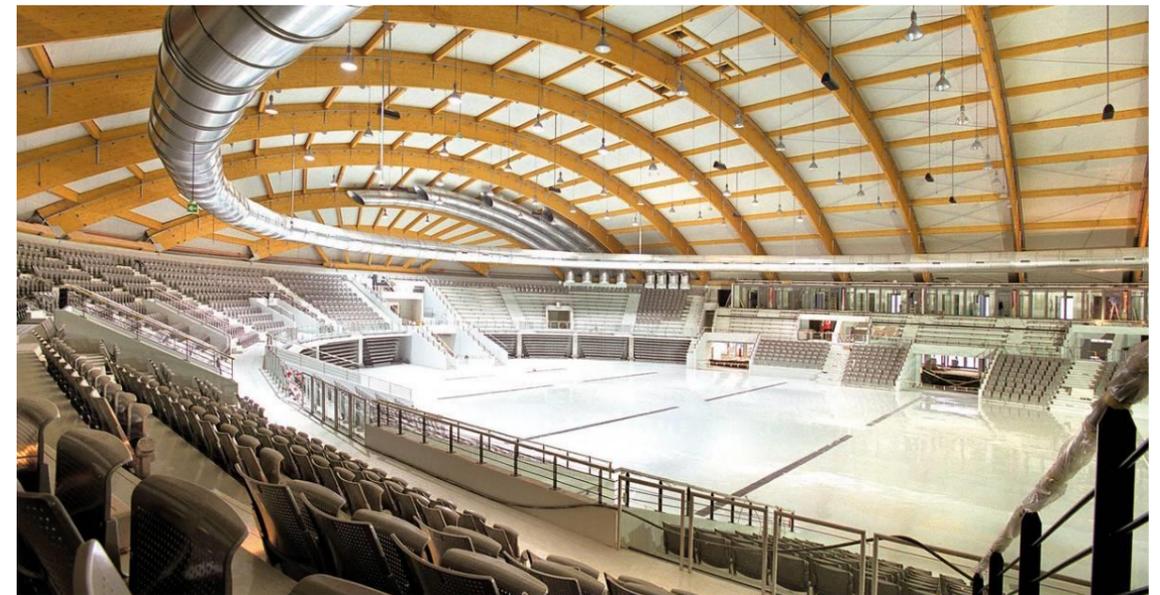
Innenbereich der Halle mit Holzdachkonstruktion, Quelle: Salzburgarena
